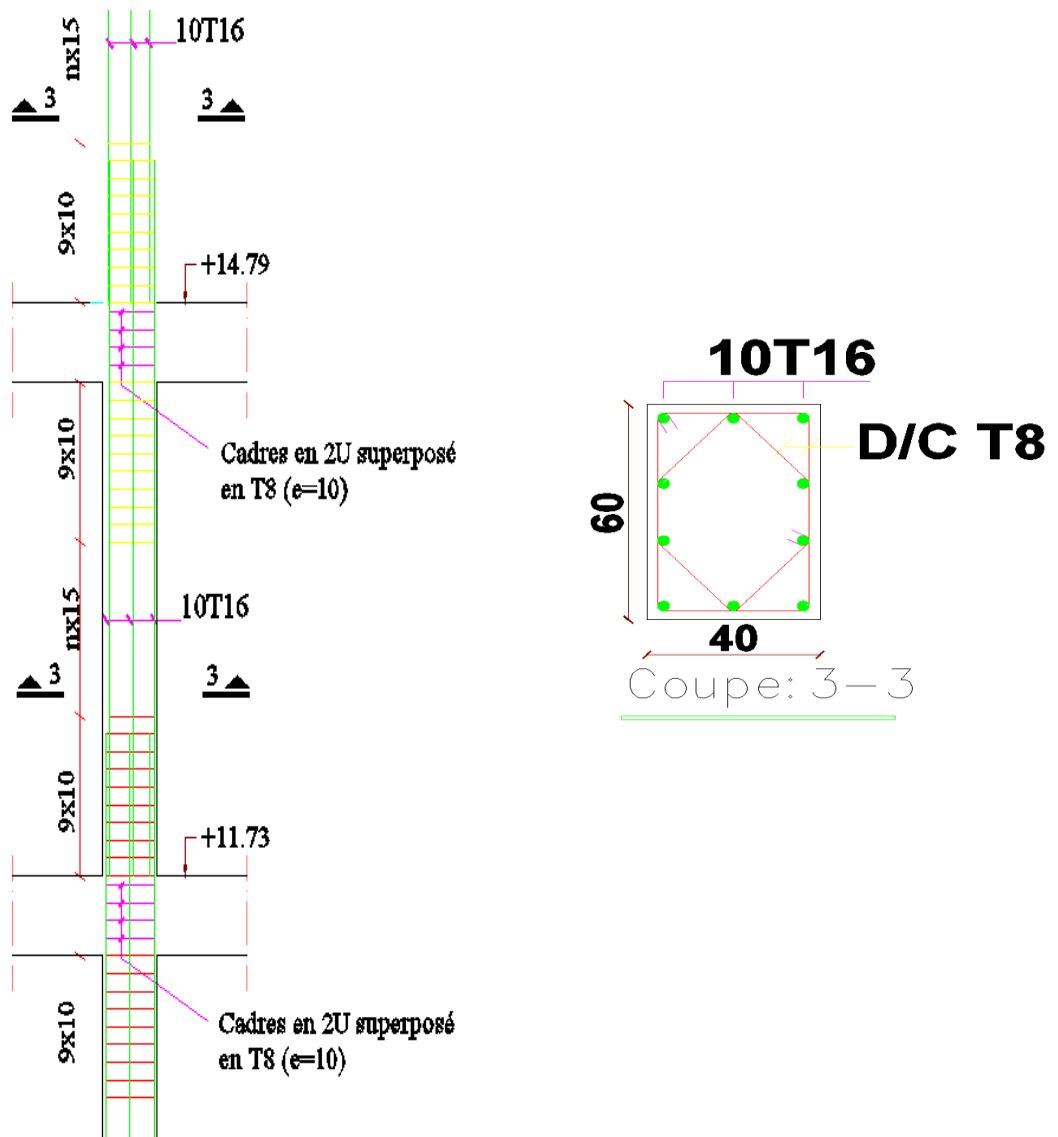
Schéma de ferraillage de poteau 40x60cm<sup>2</sup>.
